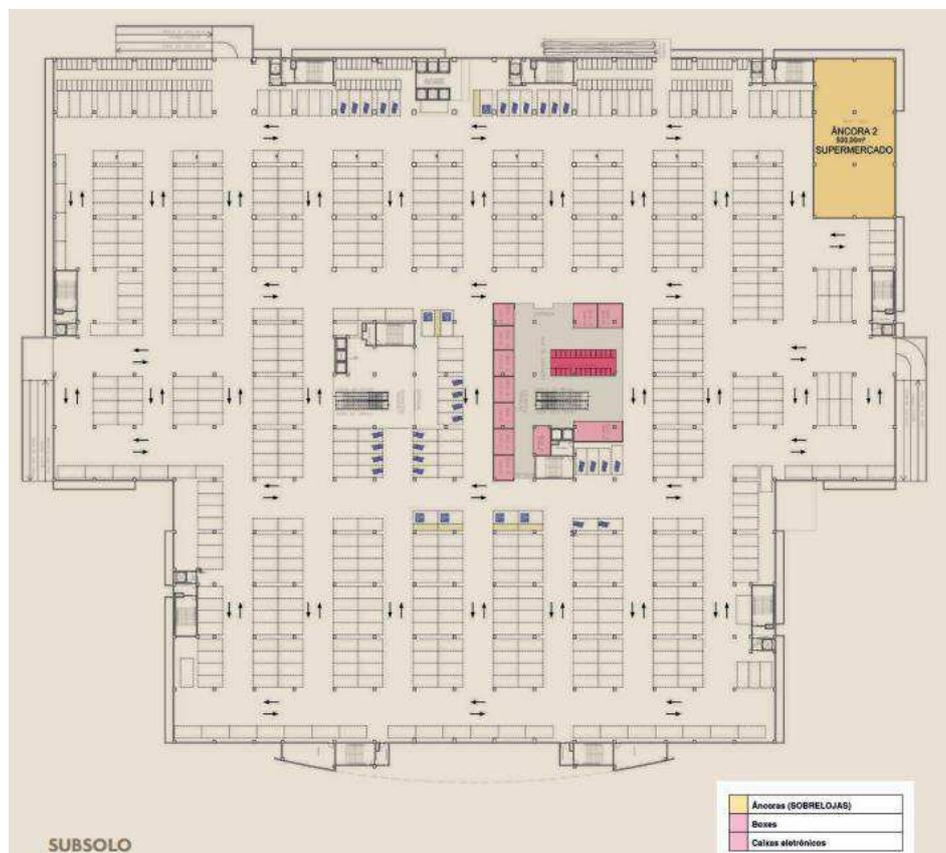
PLANTA BAIXA DO SUBSOLO.
